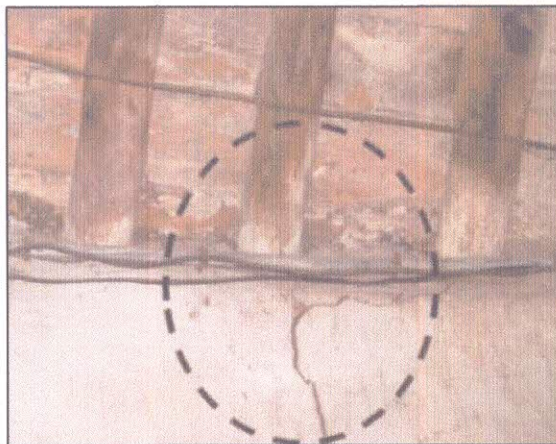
Fissures démarrant à la hauteur du plancher
